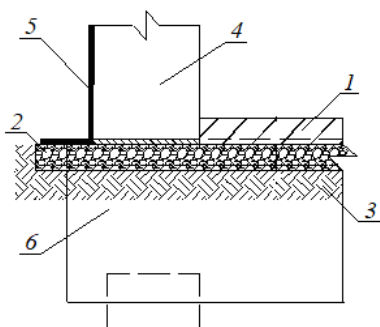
Фрагментированный барьер в виде опирающейся на поперечные балки ростверка плиты пола: 1 — монолитный, армированный дорожной сеткой бетон; 2 — слой щебня, пролитый расплавленным битумом до полного насыщения; 3 — уплотнённый грунт; 4 — наружная цокольная панель опирающаяся углами на балки ростверка; 5 — гидроизоляция из обмазочного или рулонного материала; 6 — поперечная балка незамкнутого по периметру ростверка
